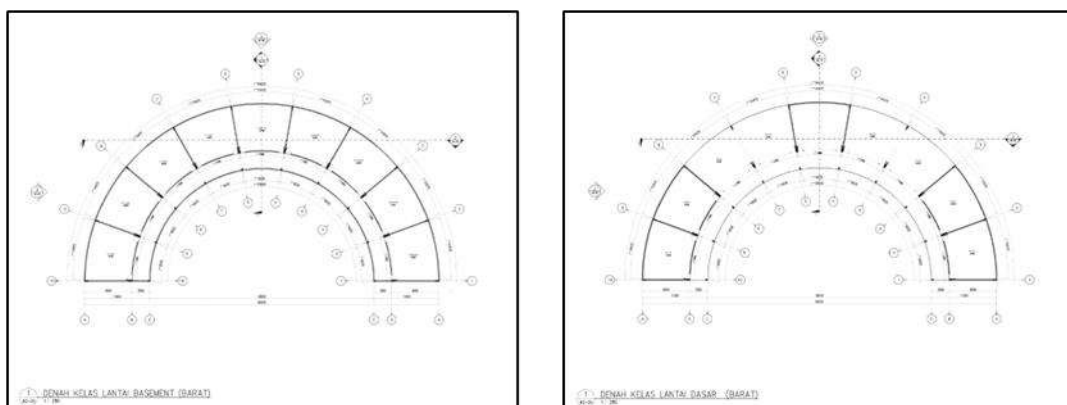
Denah Zona I Lantai Dasar dan Lantai 1
